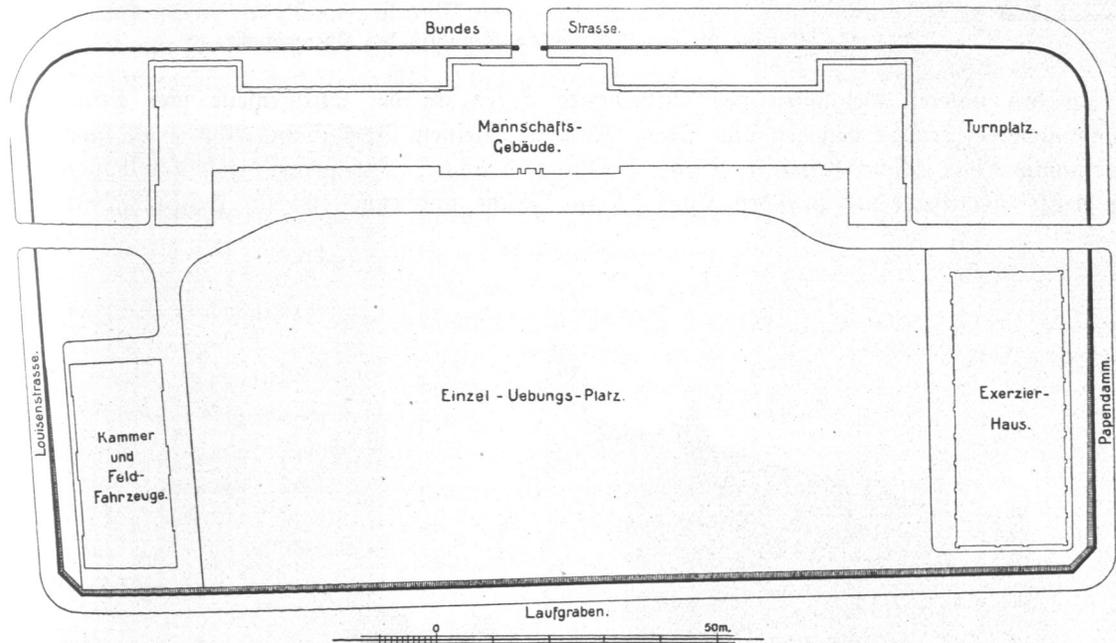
Kaserne für das 3. Bataillon, Lageplan.
